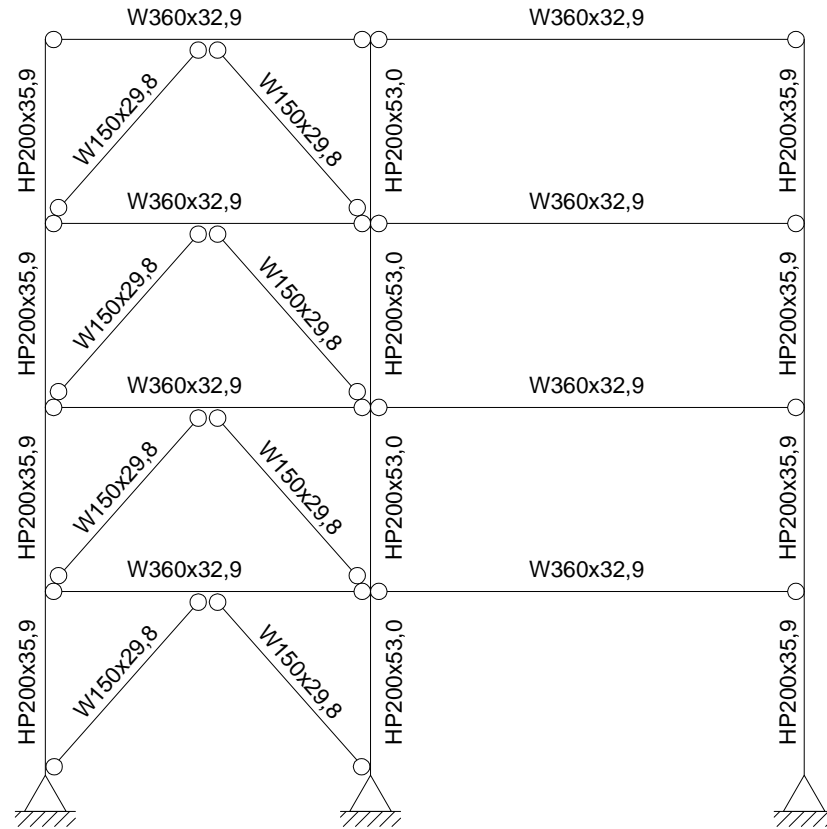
Modelo estrutural e seções adotadas para o pórtico de quatro pavimentos.
